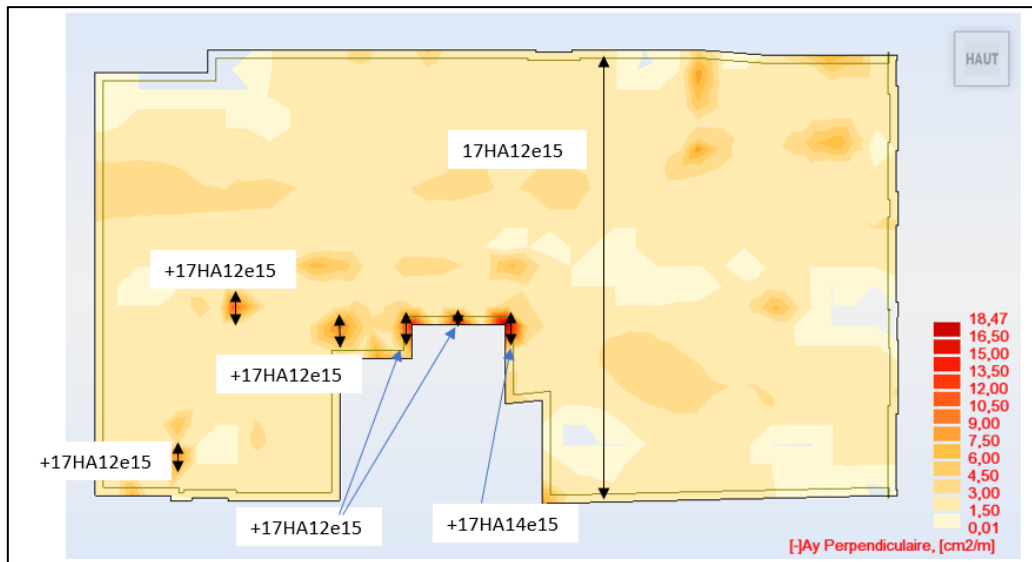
Schéma de ferrailage du plancher haut 1er étage (lit inférieur d'armatures Ay(-))
